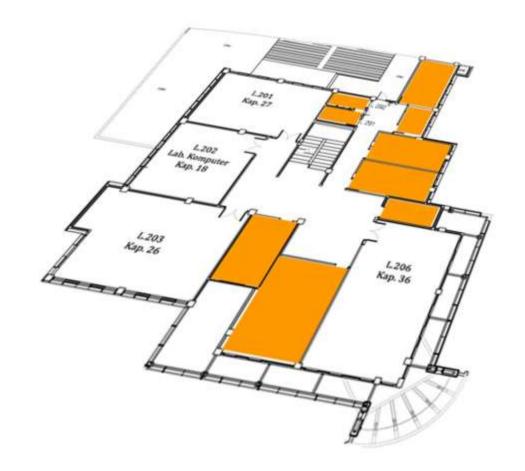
Denah Ruang Kuliah Gedung K Lantai 2
